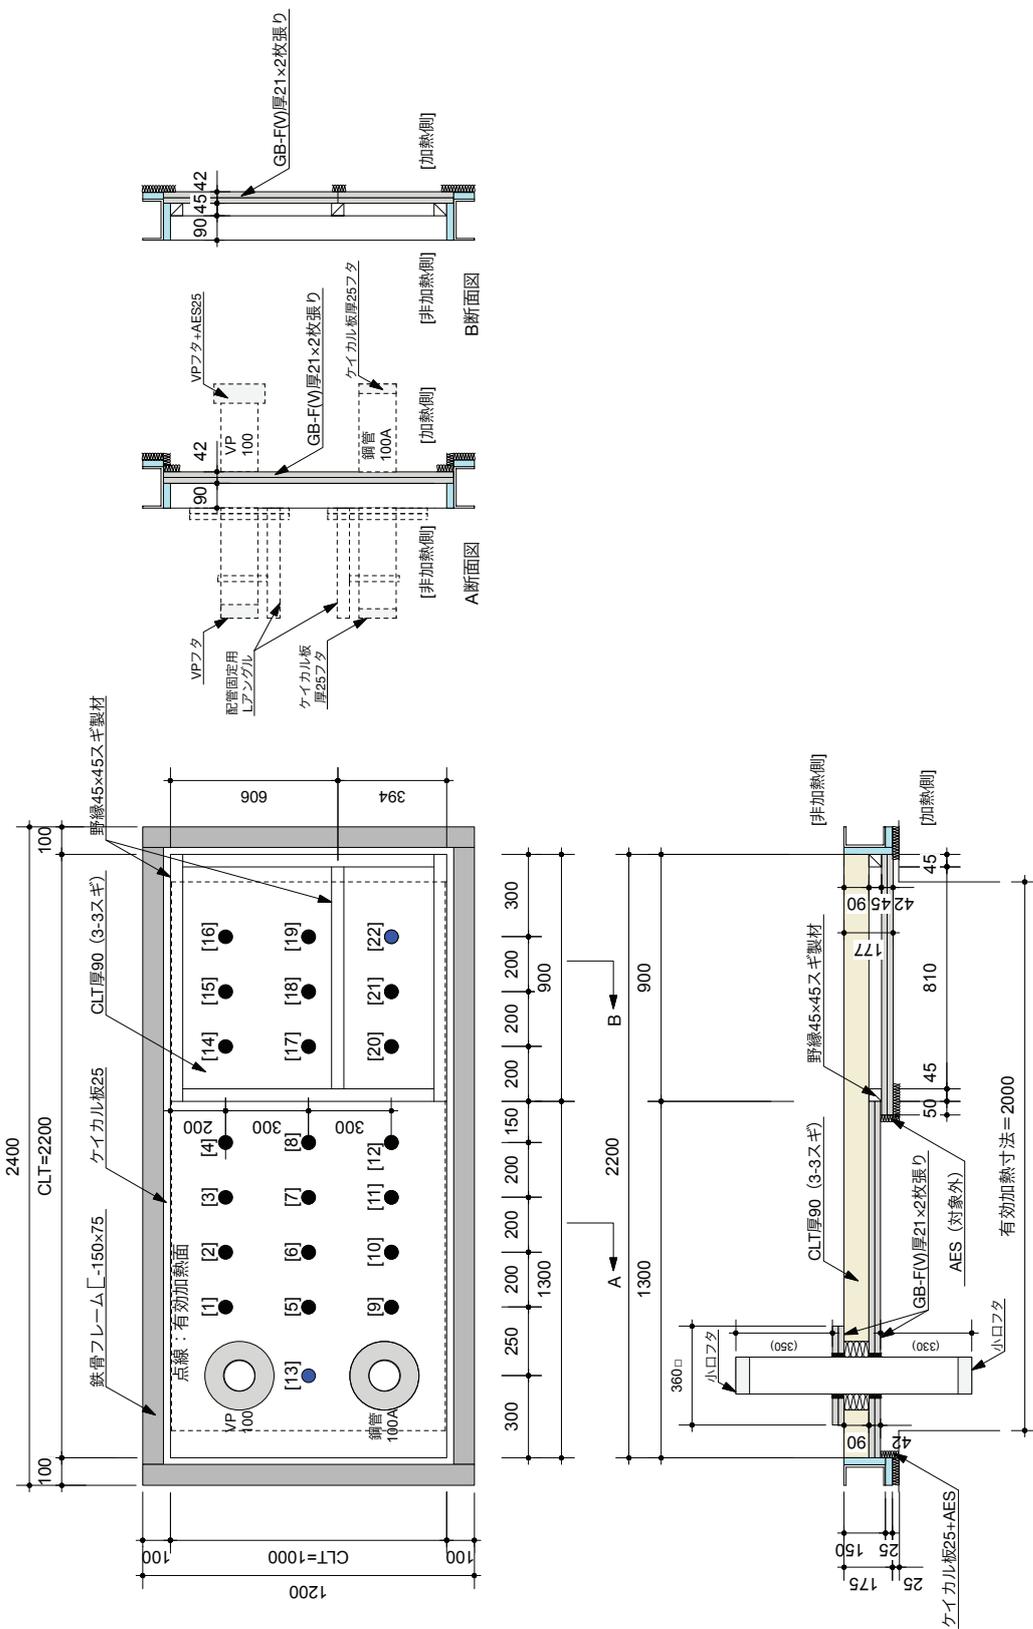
試験体 3 の構造・寸法 (単位 : mm)
